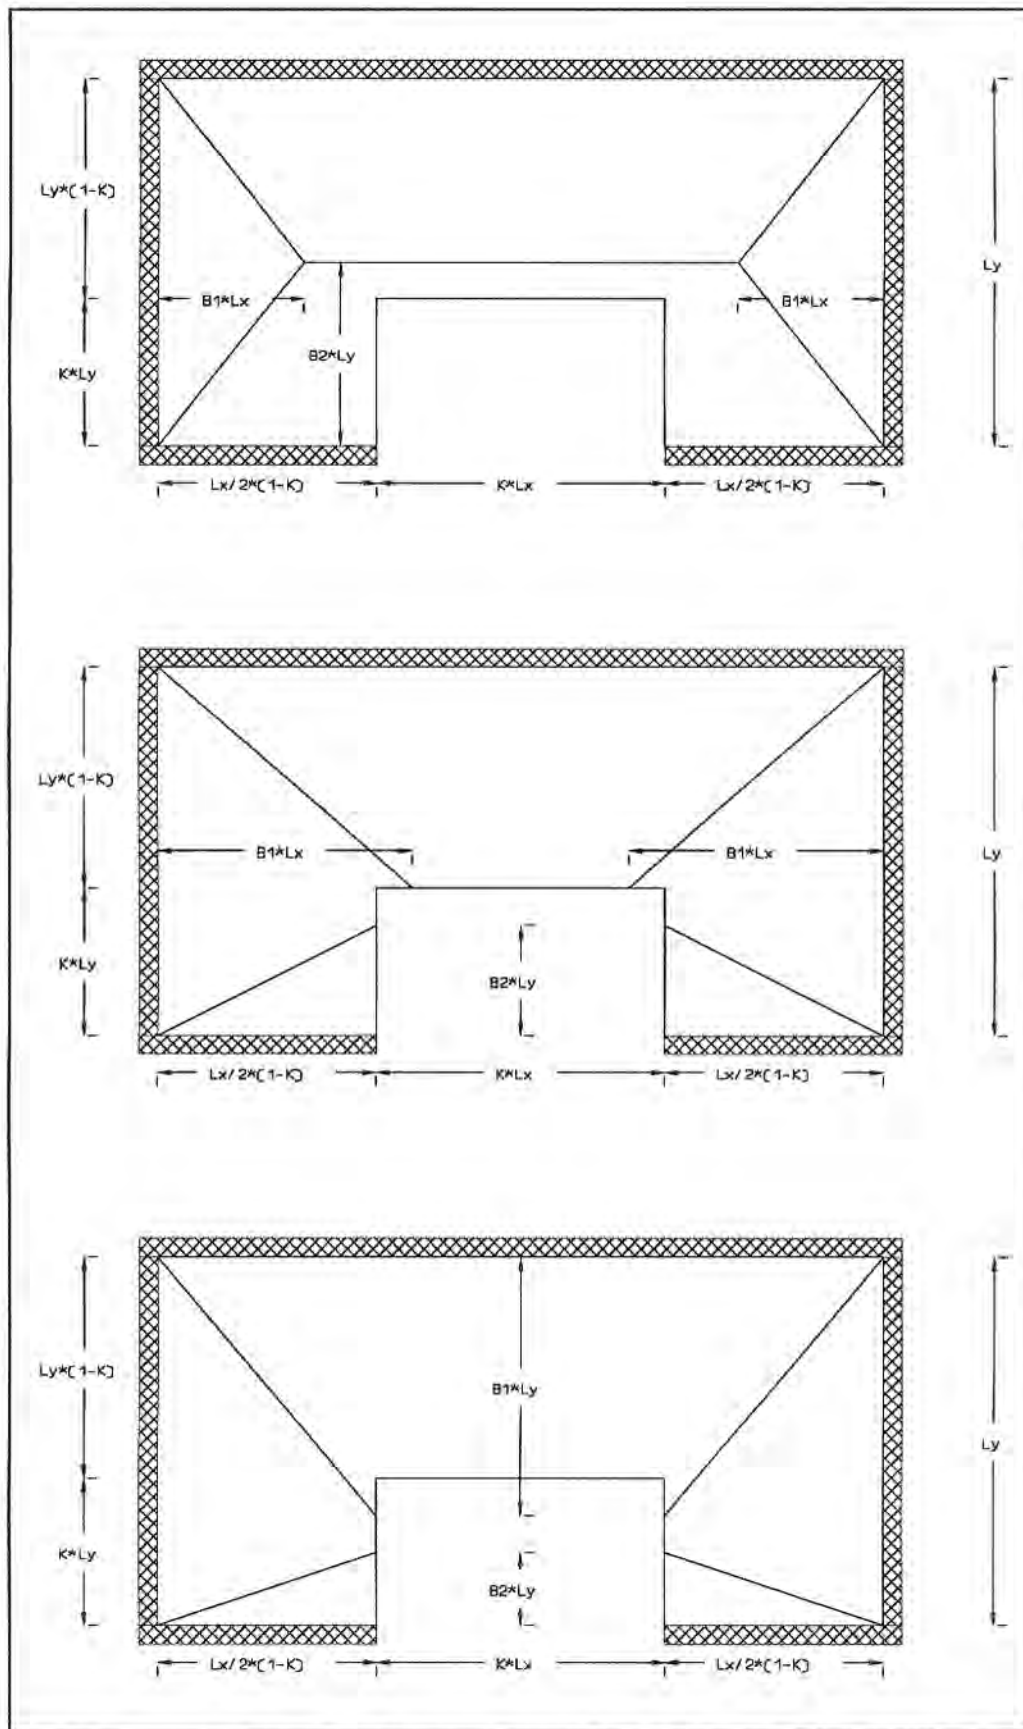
Losa rectangular uniformemente cargada, con una abertura a la mitad del lado largo.
